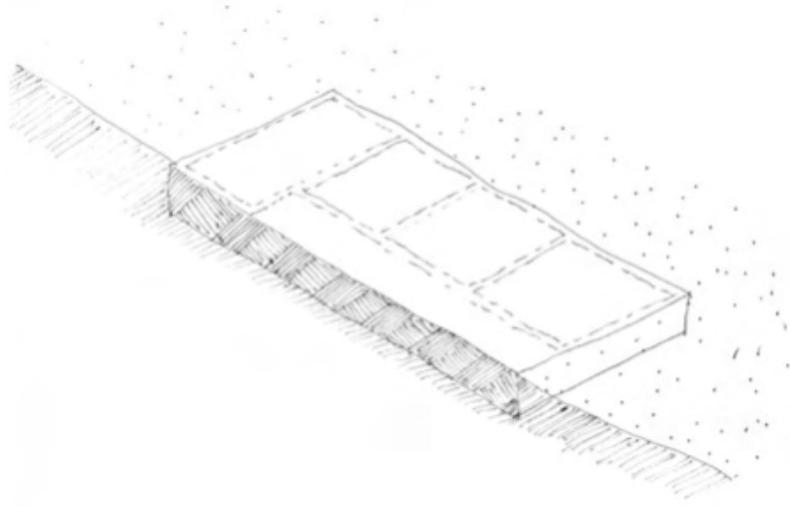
Haus ohne Fundament, verdichteter Boden unter einem typischen Grundriss
